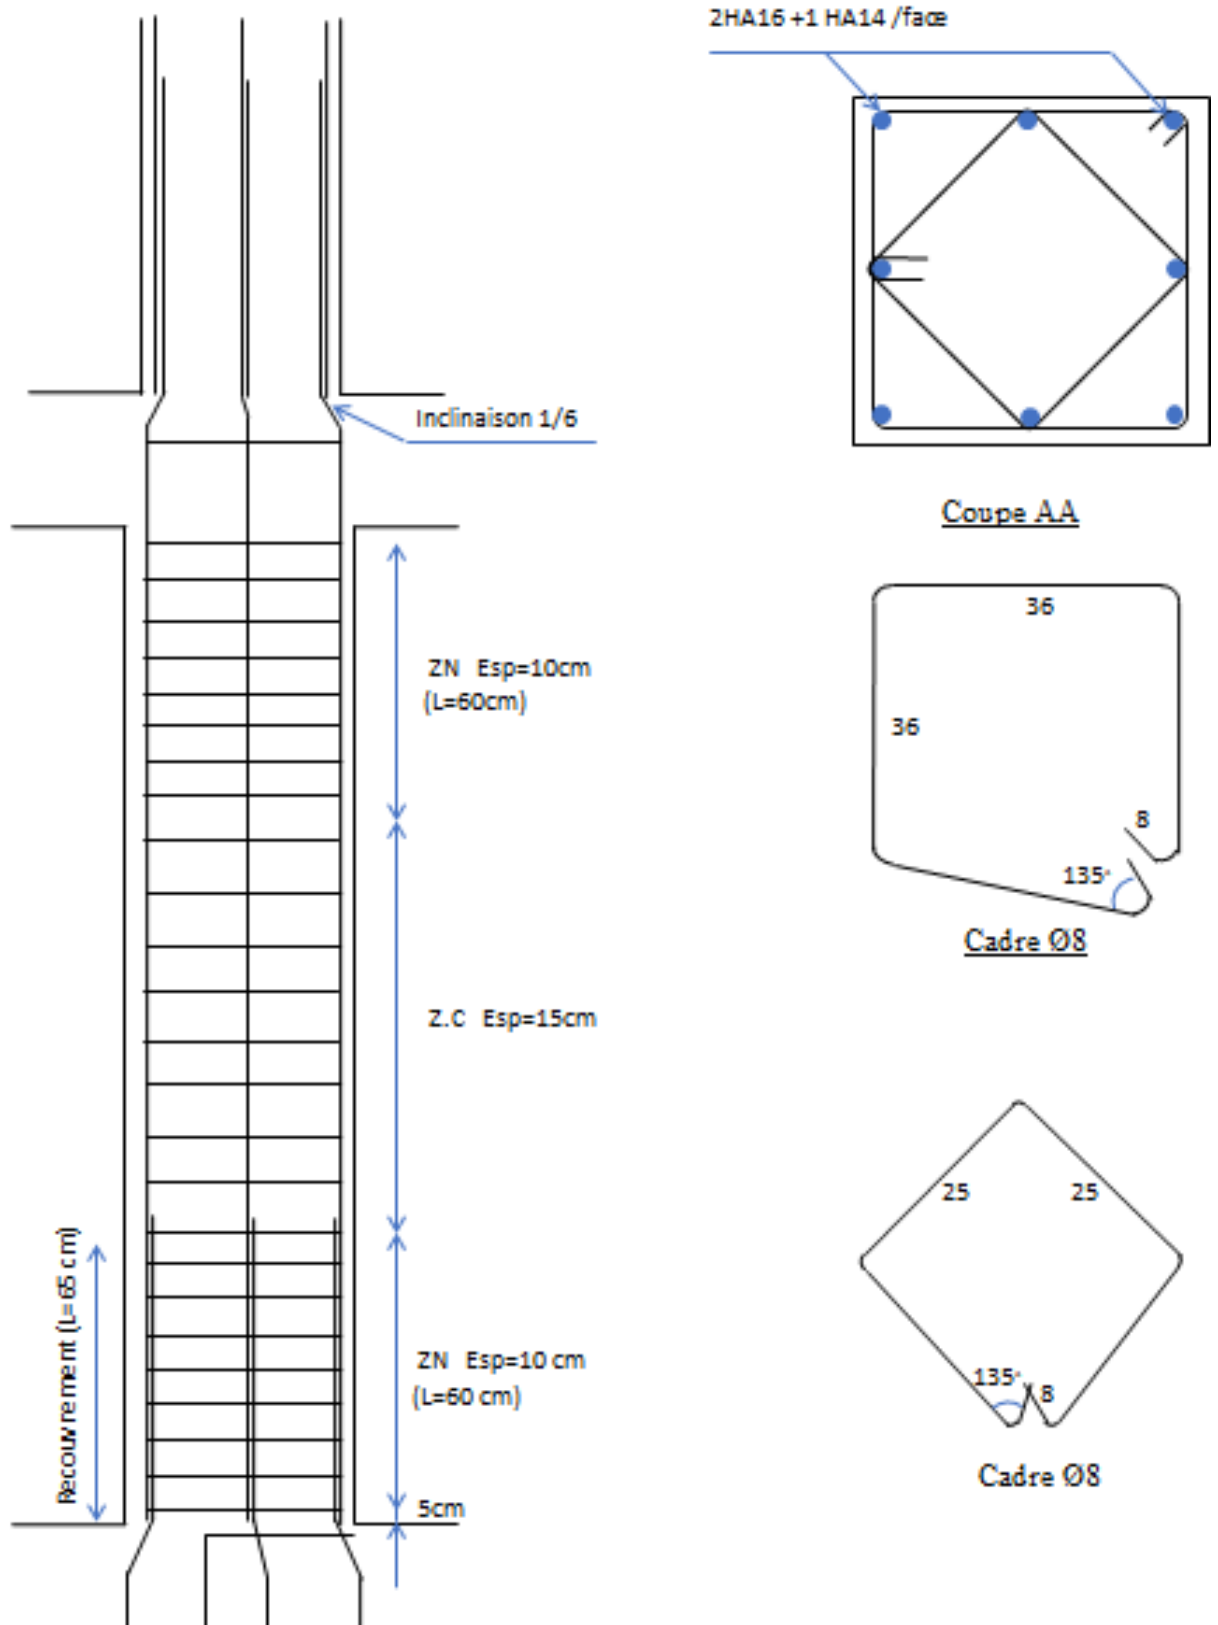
Schéma de Ferrailage du Poteau 40\*40
